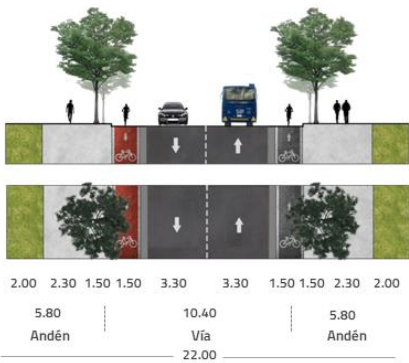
Perfil vial Avenida parque guaymaral sur
